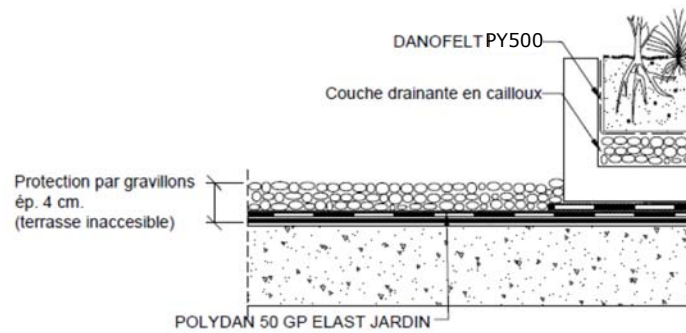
Exemple de mise en œuvre du complexe POLYDAN JARDIN – Cas des murets construits sur le revêtement d'étanchéité sur éléments porteur en maçonnerie (cf. § 2.4.8.6)
